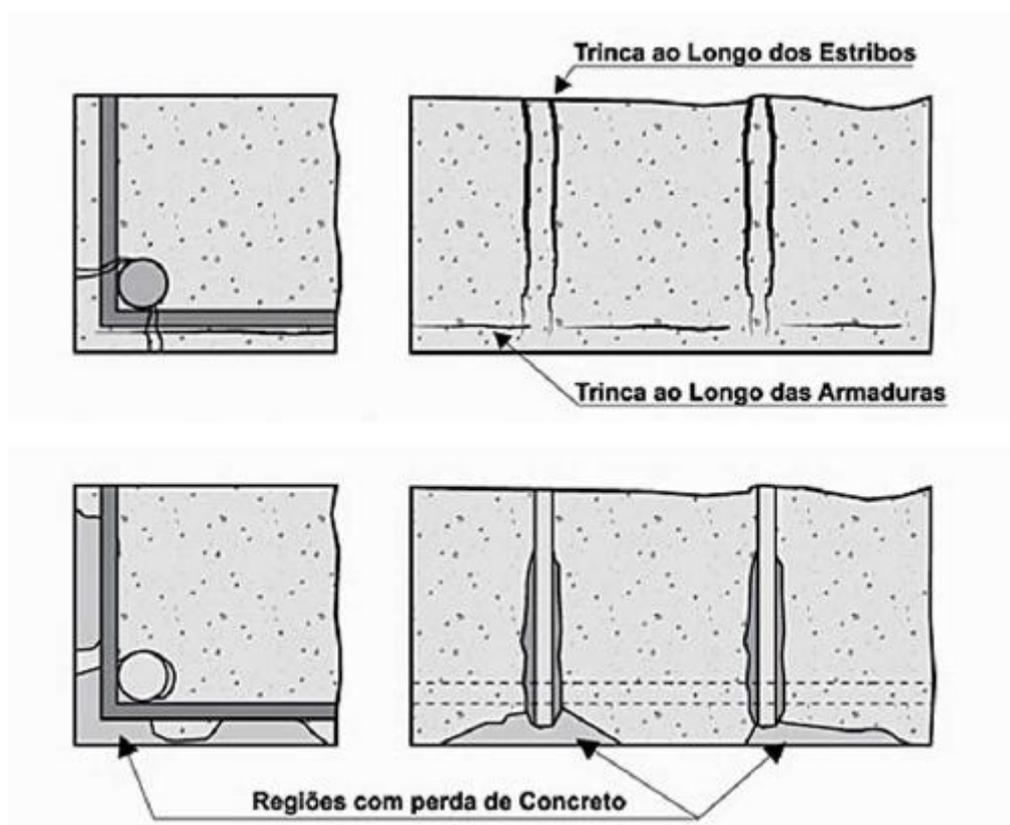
Fissuras devido a corrosão da armadura (MARCELLI, 2007).
